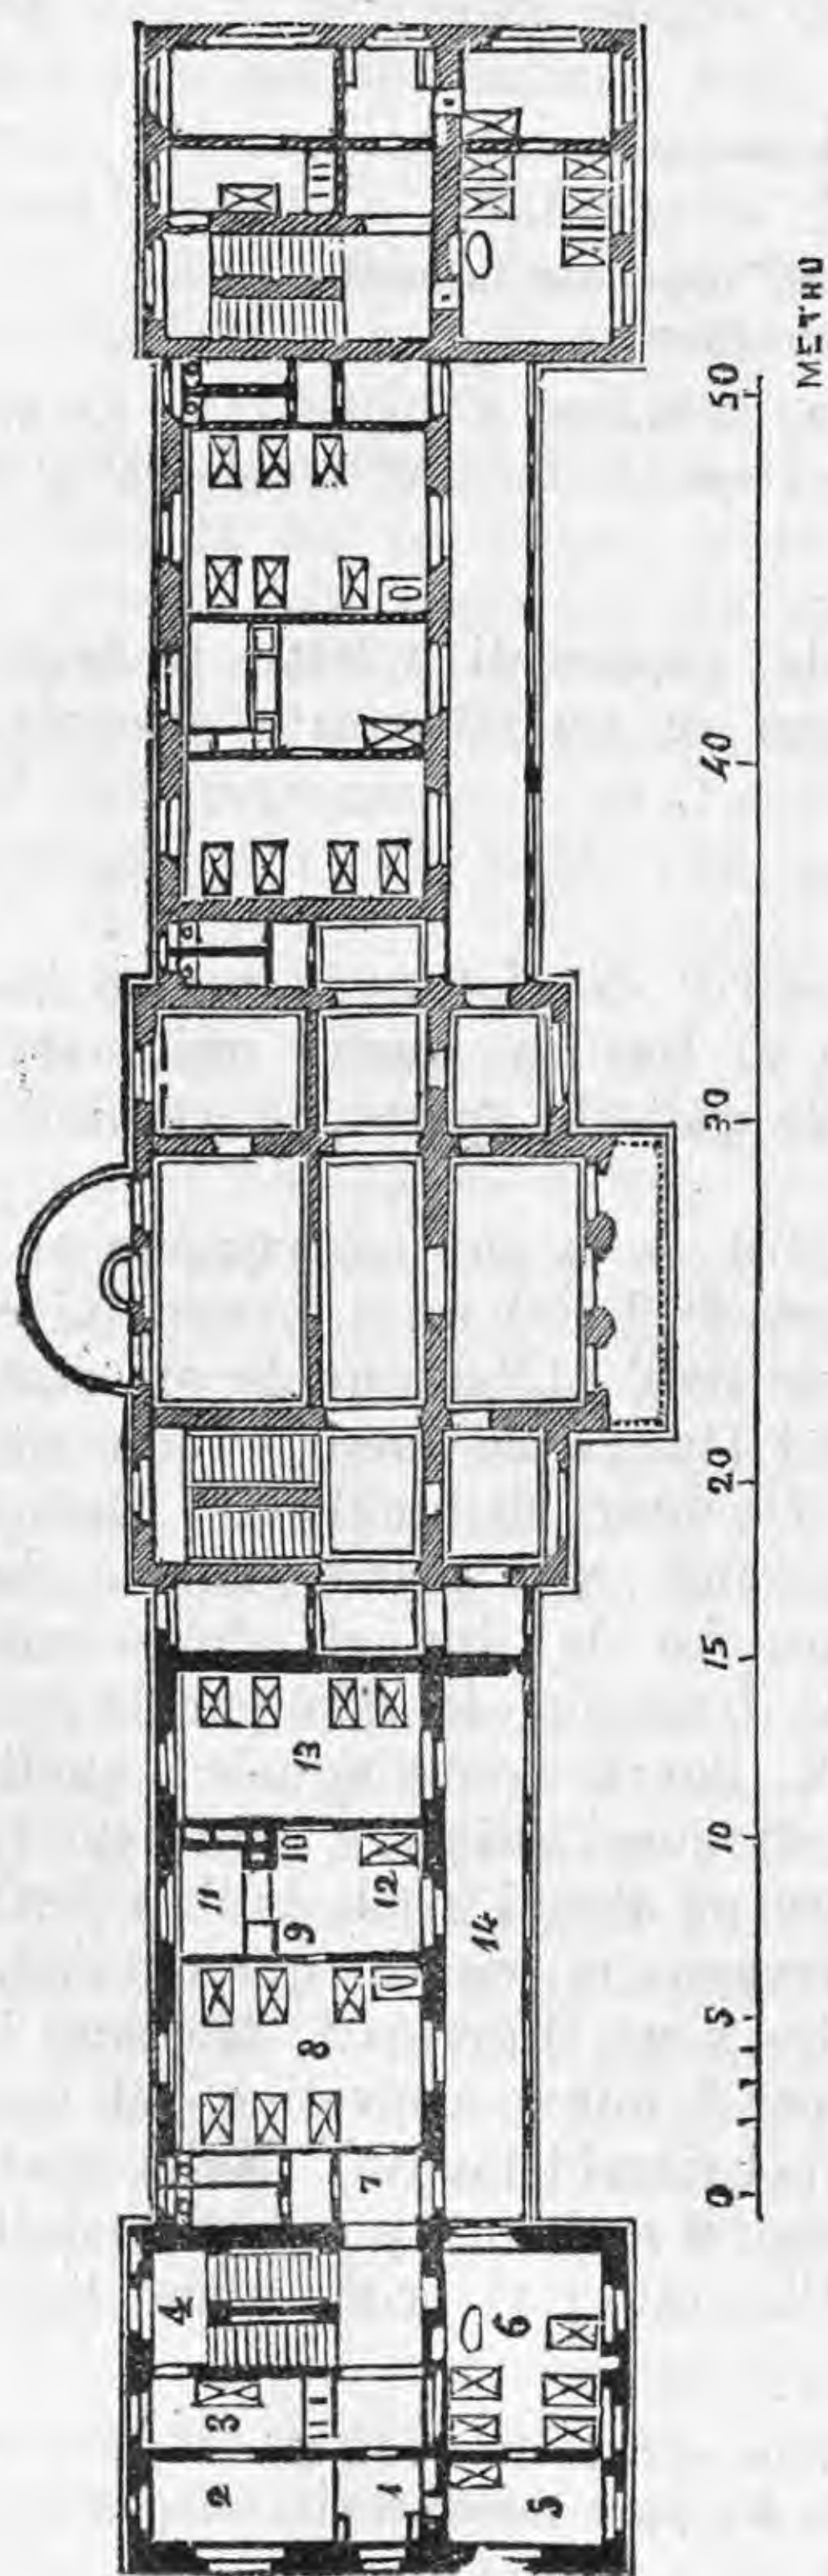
Pianta del primo piano dell' ospedale infantile di Hottingen.
